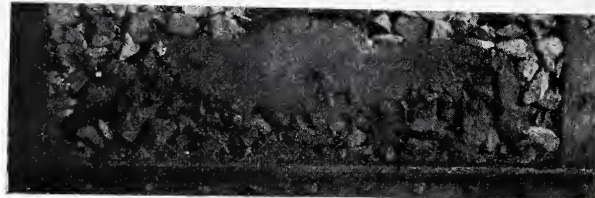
Querschnitt des bewegten Bettungskörpers einer Steinbettung.
